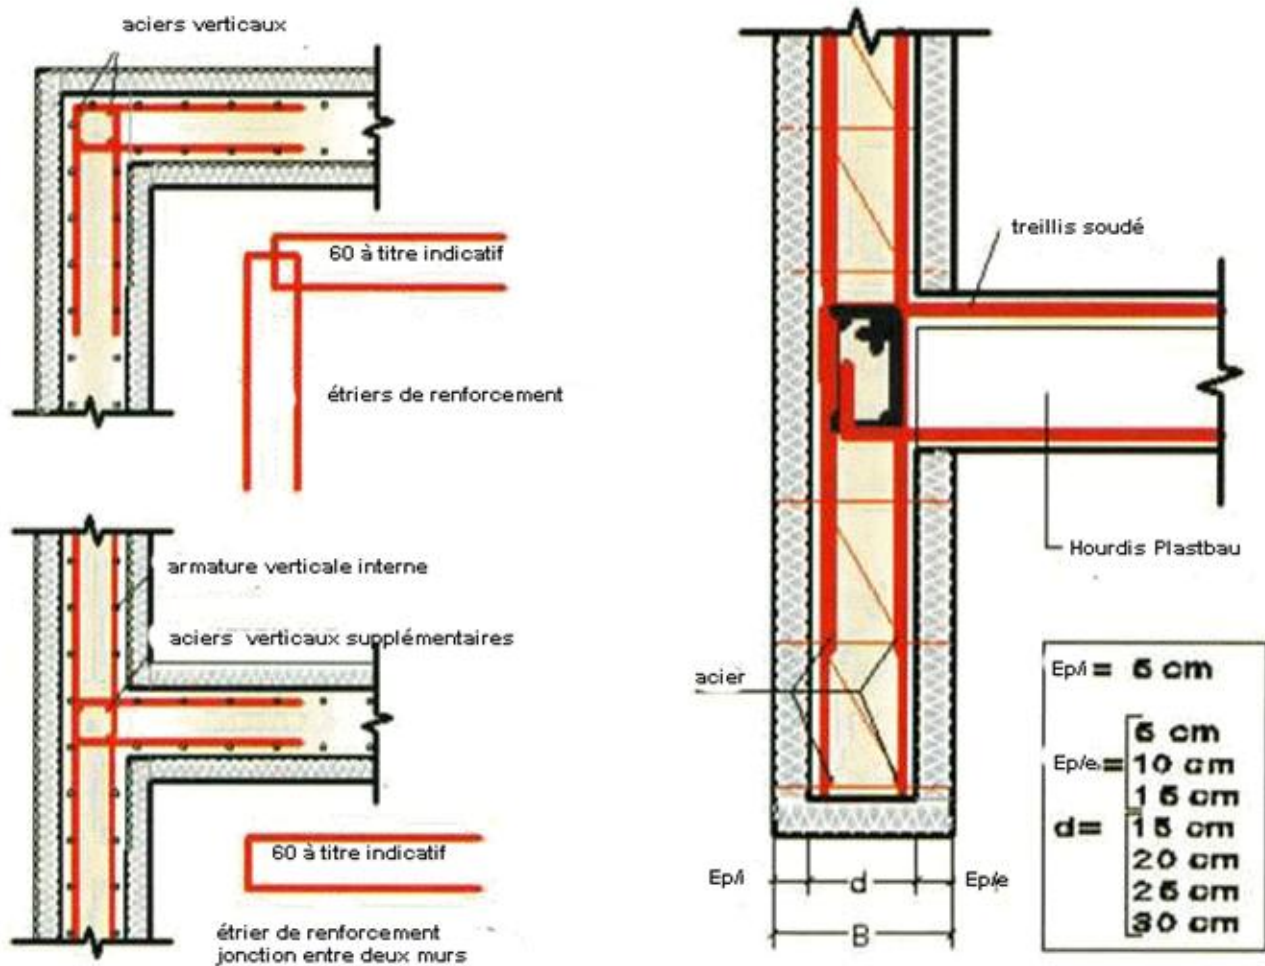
section horizontale des armatures pour angle, mur de refend et linteau
